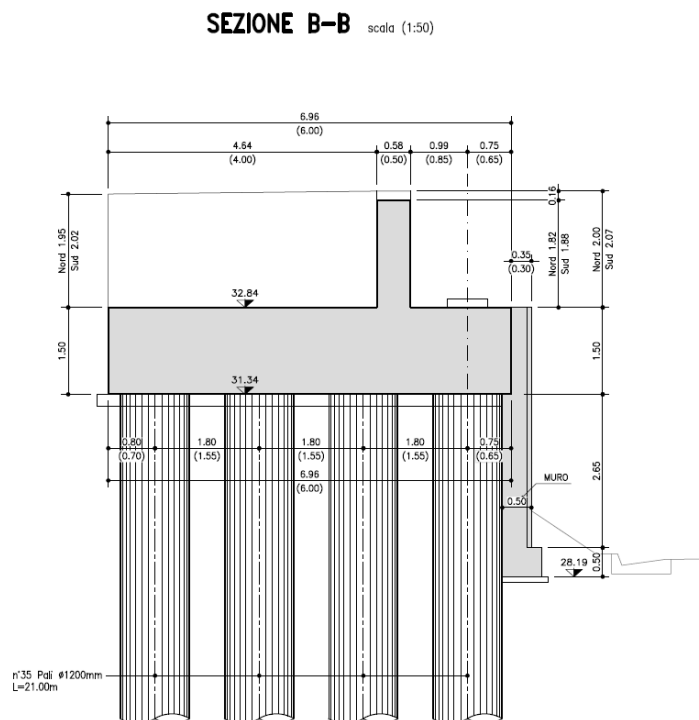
Sezione trasversale della Spalla A
